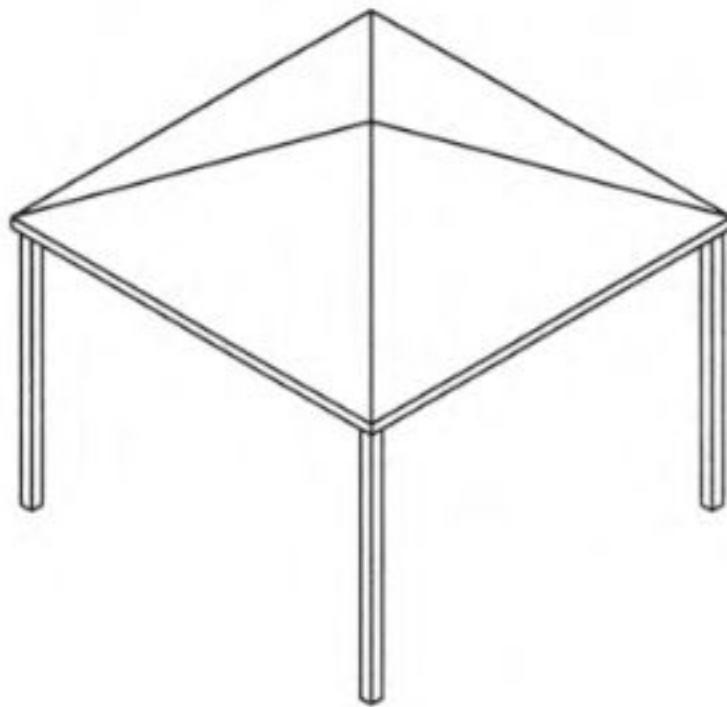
Простую беседку можно собрать в саду, установив на четырёх стойках размерами 10x10x270 см лёгкую шатровую крышу, для которой нужны всего 8 строганых досок 45x95x3300 мм и чехол из плотной палаточной ткани для кровли. При установке на бетонные фундаменты стойки нужно укоротить.
